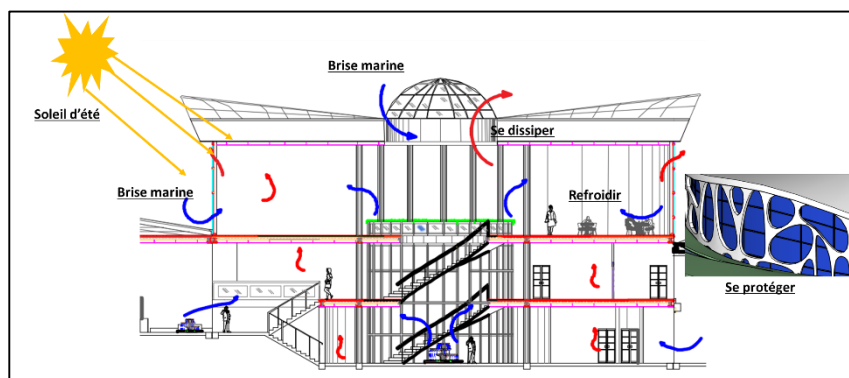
Ventilation naturelle au niveau de hall d'accueil en été. source : hauteur
